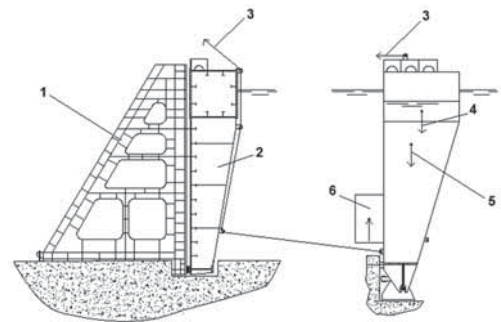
Схема раскрепления нового затвора перед его посадкой на шарнирные опоры:
